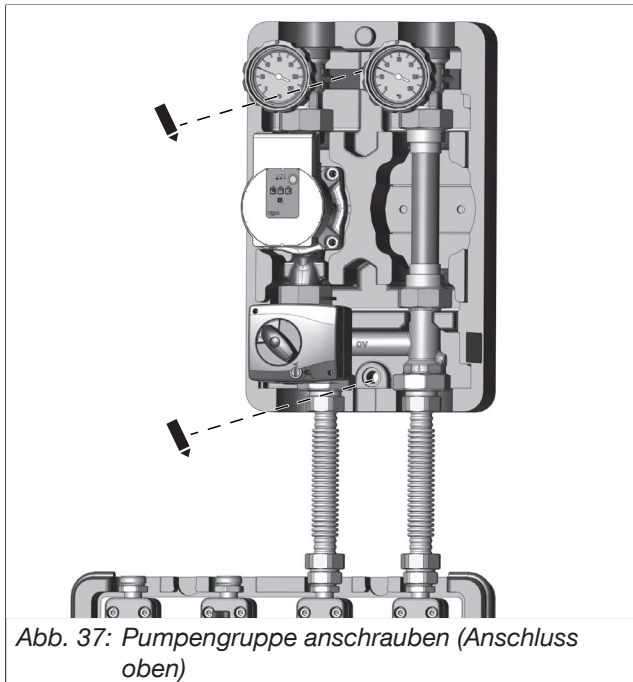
Pumpengruppe anschrauben (Anschluss oben)
